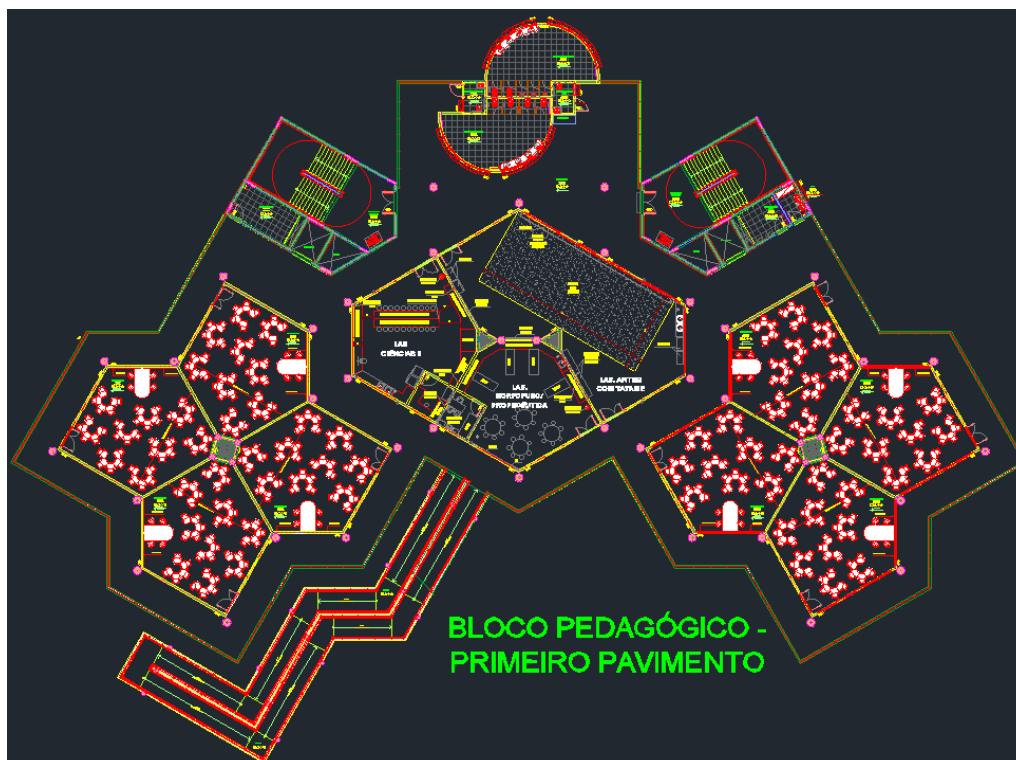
Planta do 1º pavimento do Núcleo Pedagógico CJA UFSB.
